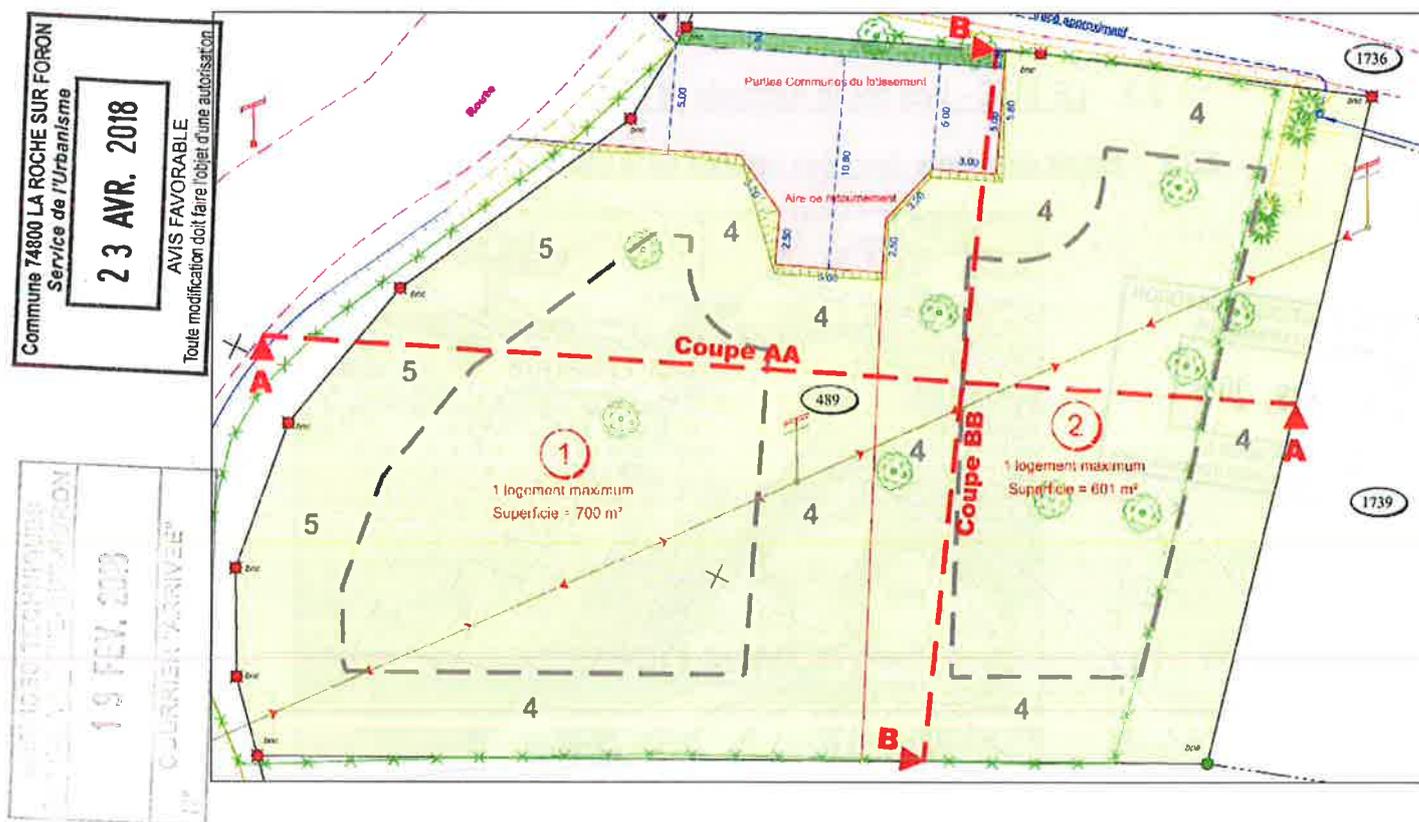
Plan de géomètre de la parcelle, avec projection des deux lots et de la partie commune
